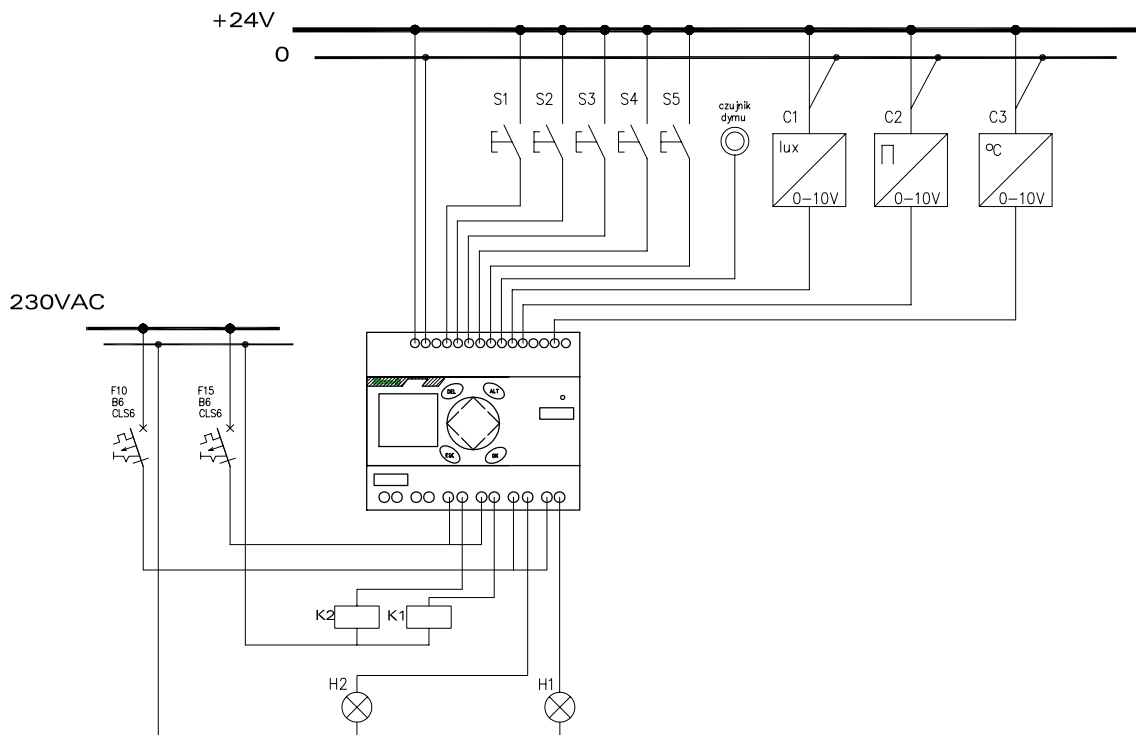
/9/8 Plan instalacji oświetlenia wewnętrznego
